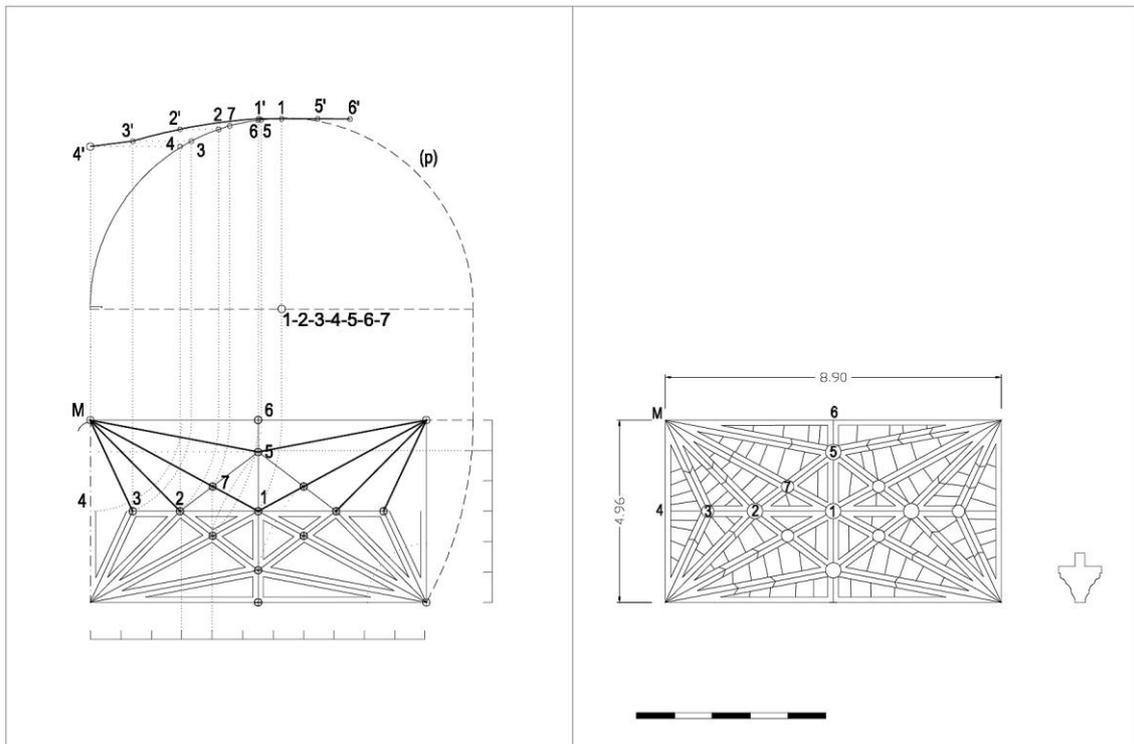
Abóbada da nave. A) Hipótese do traçado da planta e elevação. As nervuras são traçadas com um arco de circunferência de raio igual a metade do comprimento da diagonal em planta. O *rampante* é quebrado. B) Planta das aduelas da abóbada, posicionadas de forma concêntrica a partir dos quatro apoios. As nervuras têm o mesmo perfil e espessura (0,30m).
